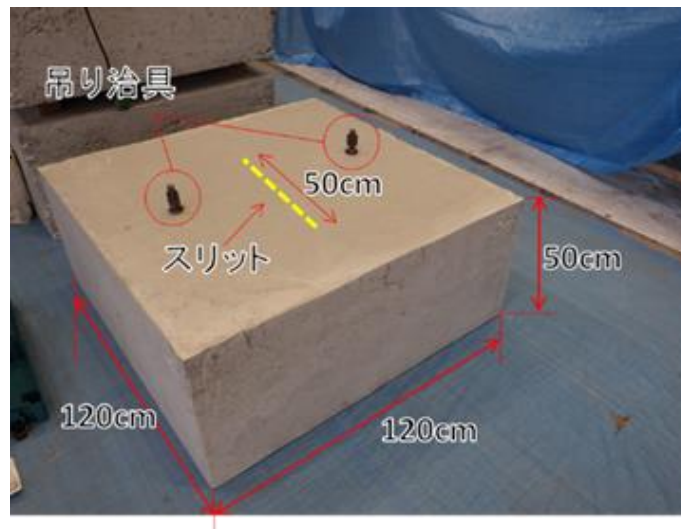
板ジャッキ工法によるひび割れ誘発試験に用いた試験体①
